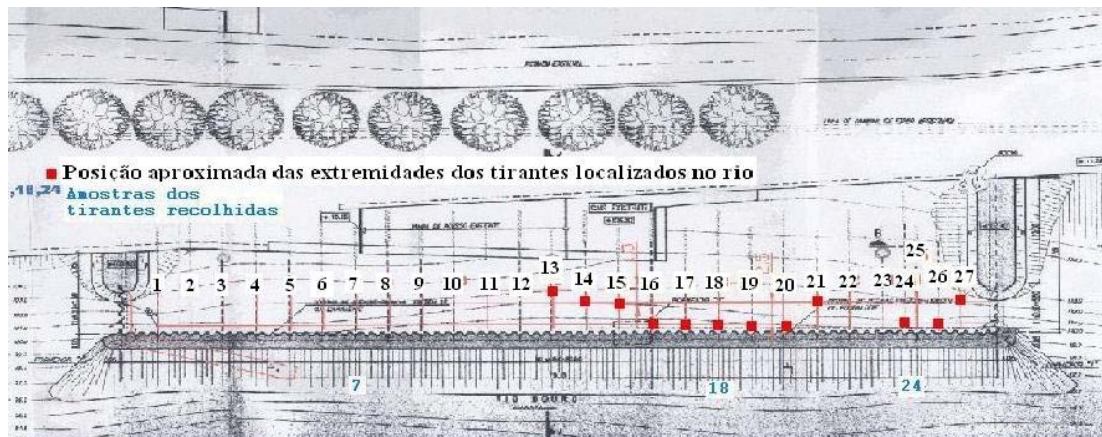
Planta com a Localização dos Tirantes das Ancoragens Encontradas
